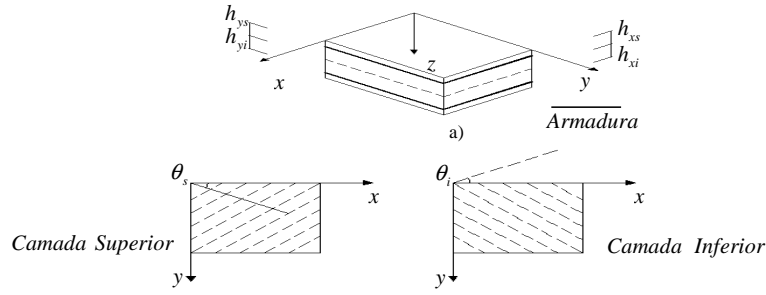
Armadura em um elemento de casca: a) Elemento de casca incluindo a armadura; b) Direção da fissura (adaptado de [8])
